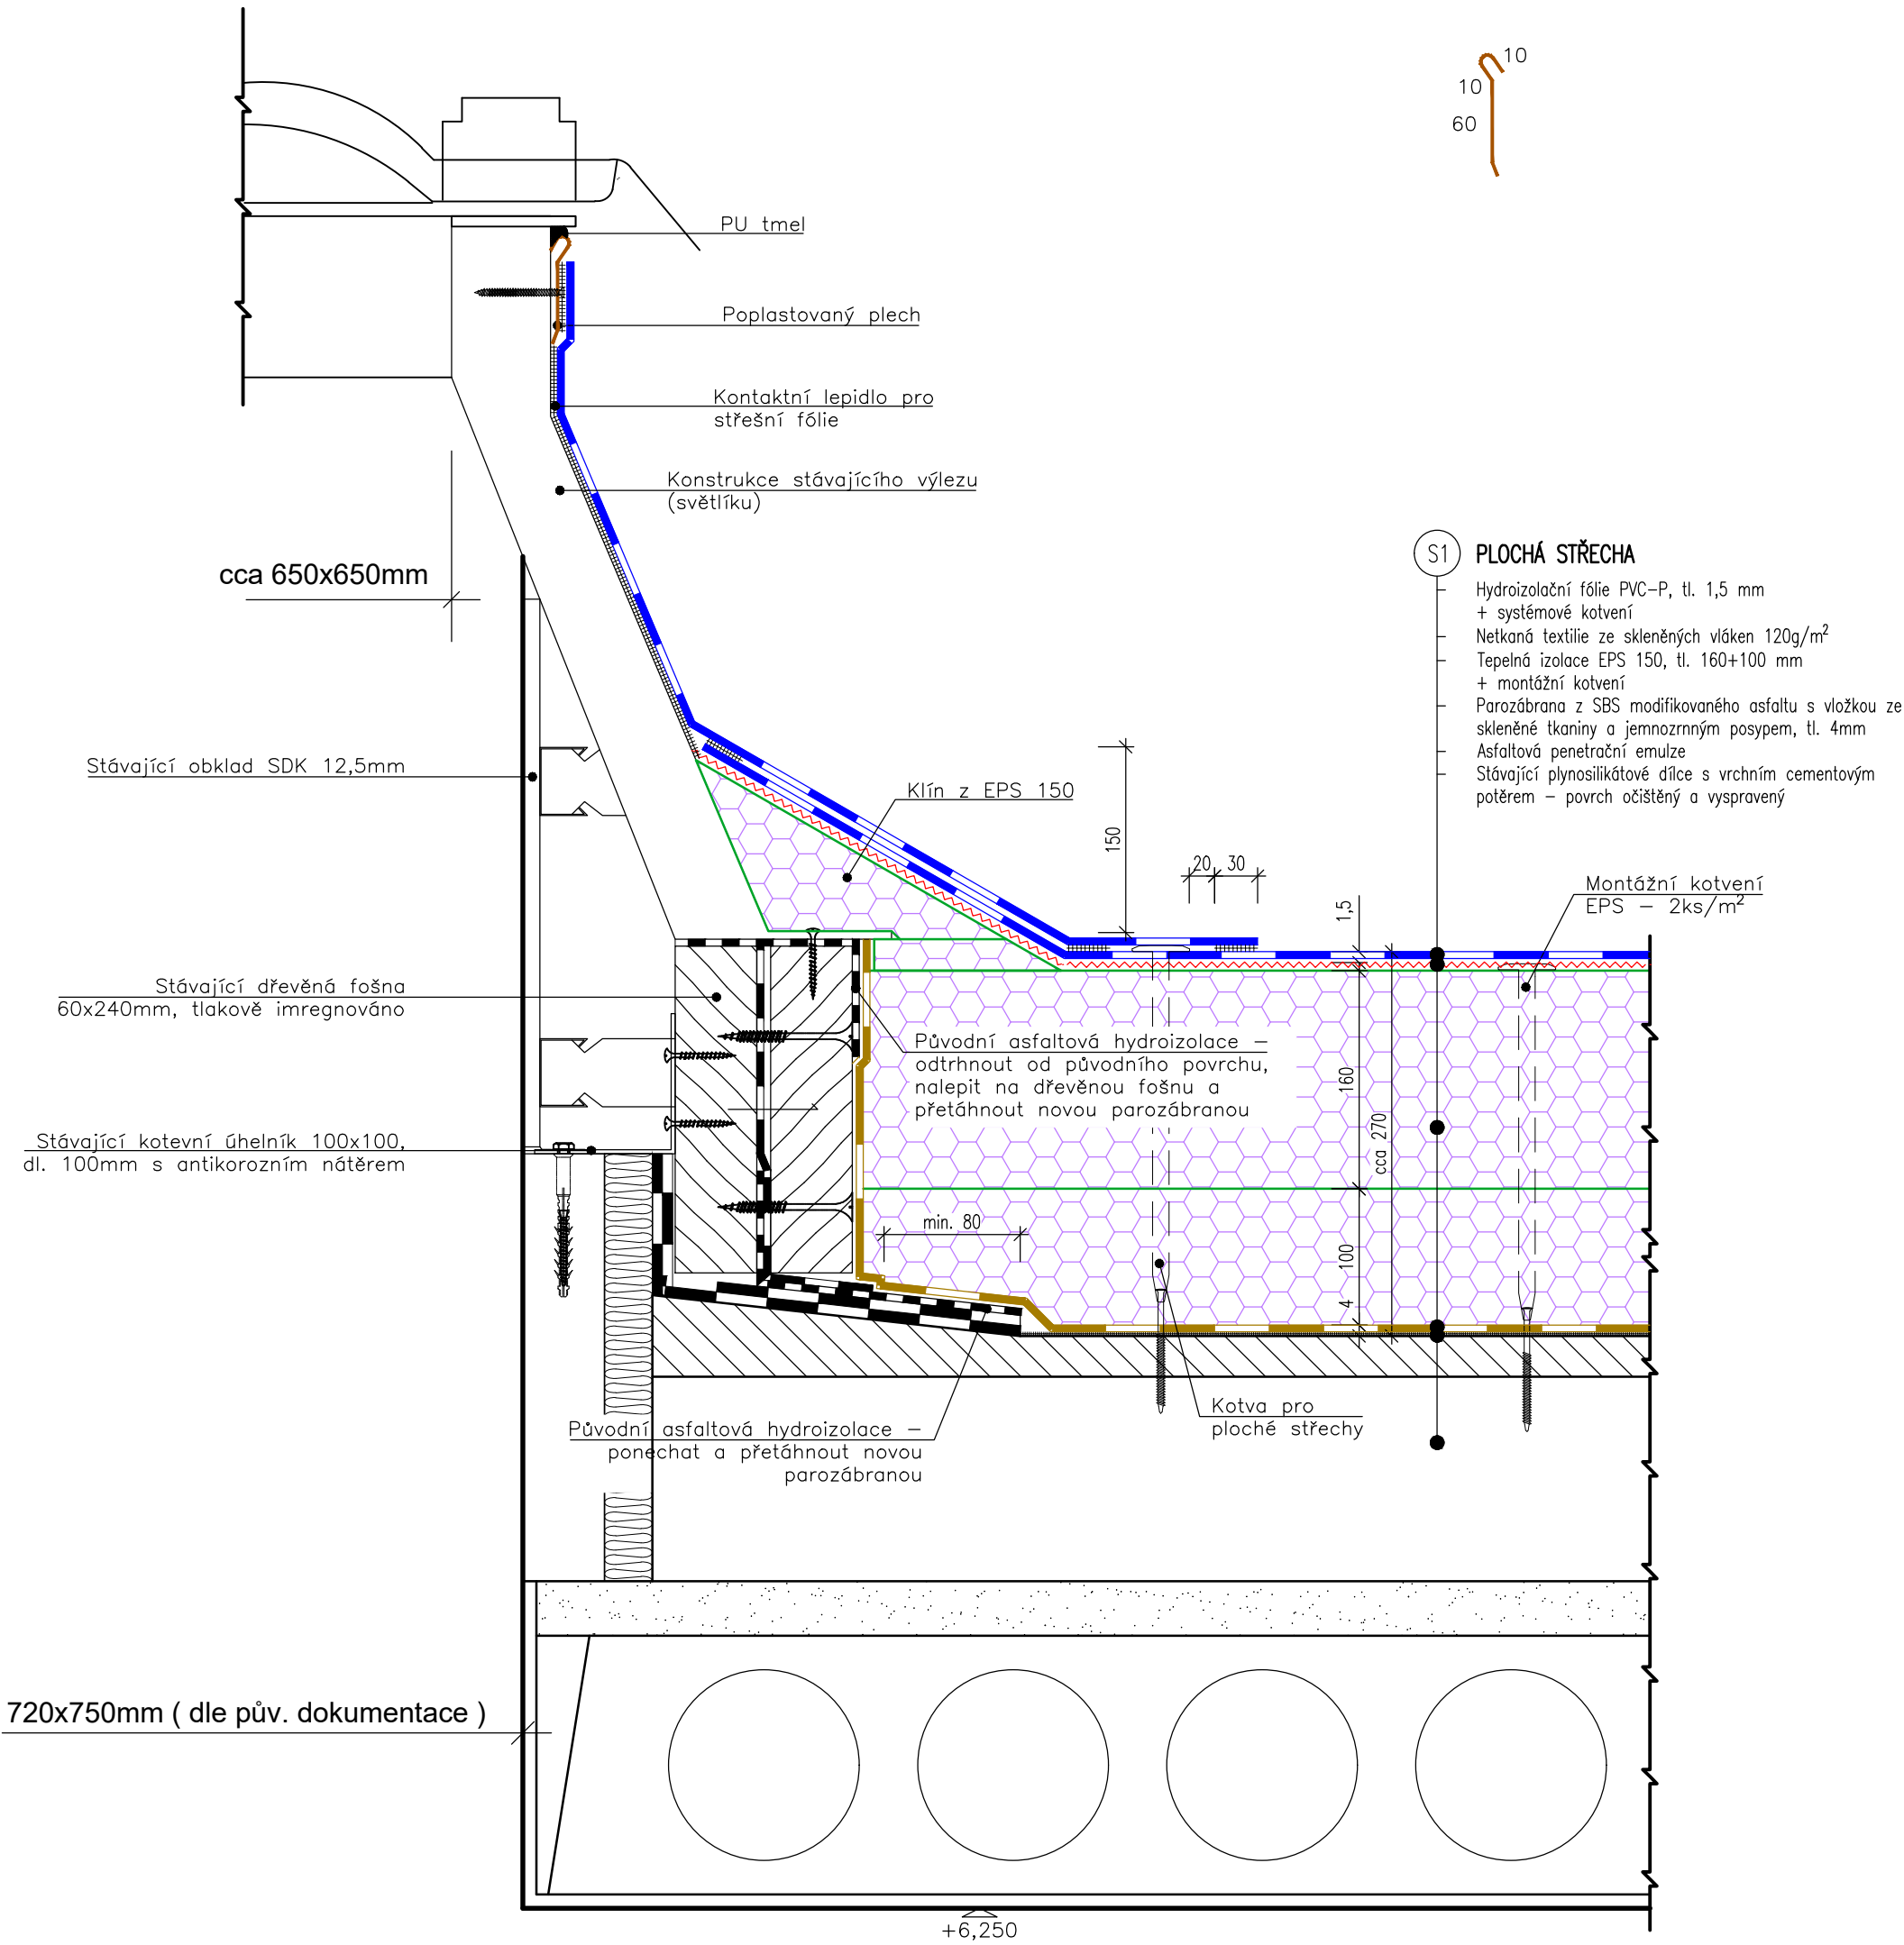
DETAIL STŘEŠNÍHO VÝLEZU, M1:5
